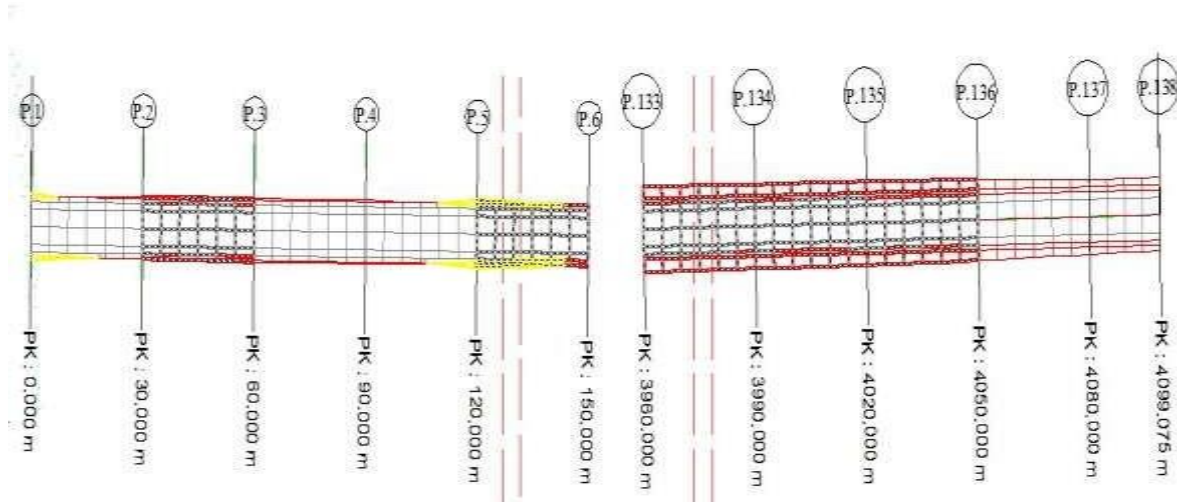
Extrait tracé en plan de notre route (cas de la variante retenue)
